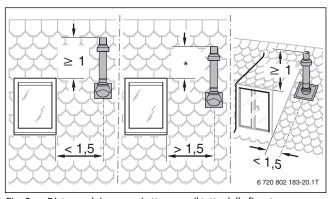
Distanze dei passaggi attraverso il tetto dalle finestre
